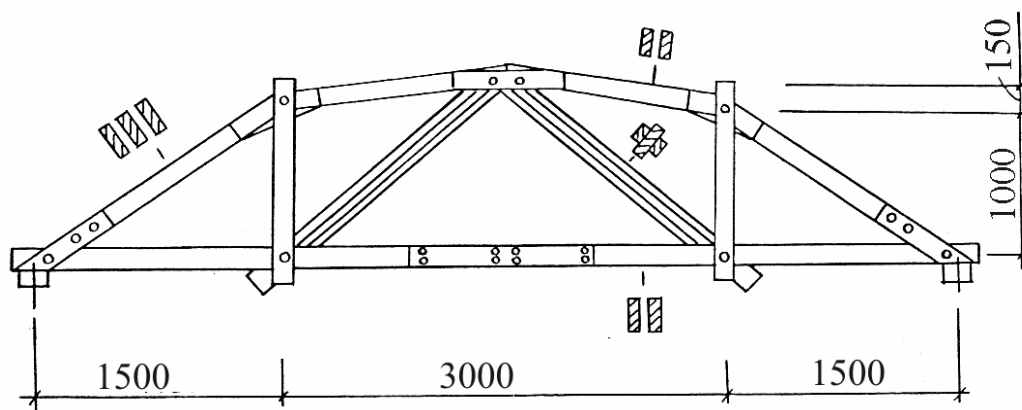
Конструкция опытной фермы с узлами на клеевых соединениях Б.С. Соколовского
